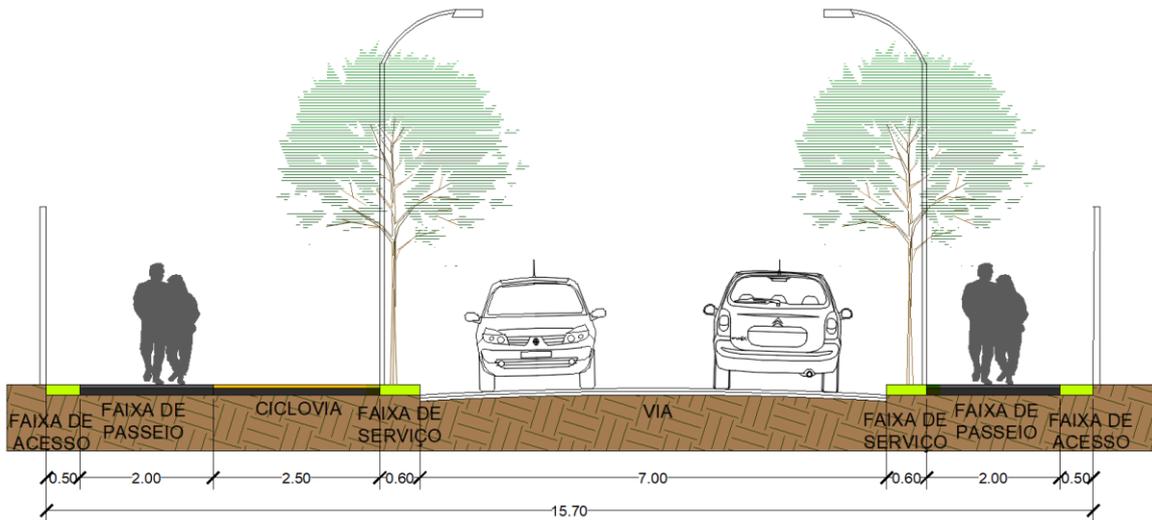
Perfil da Via de Circulação de Vizinhança 1 – Perfil 2 (Fonte: Própria)
